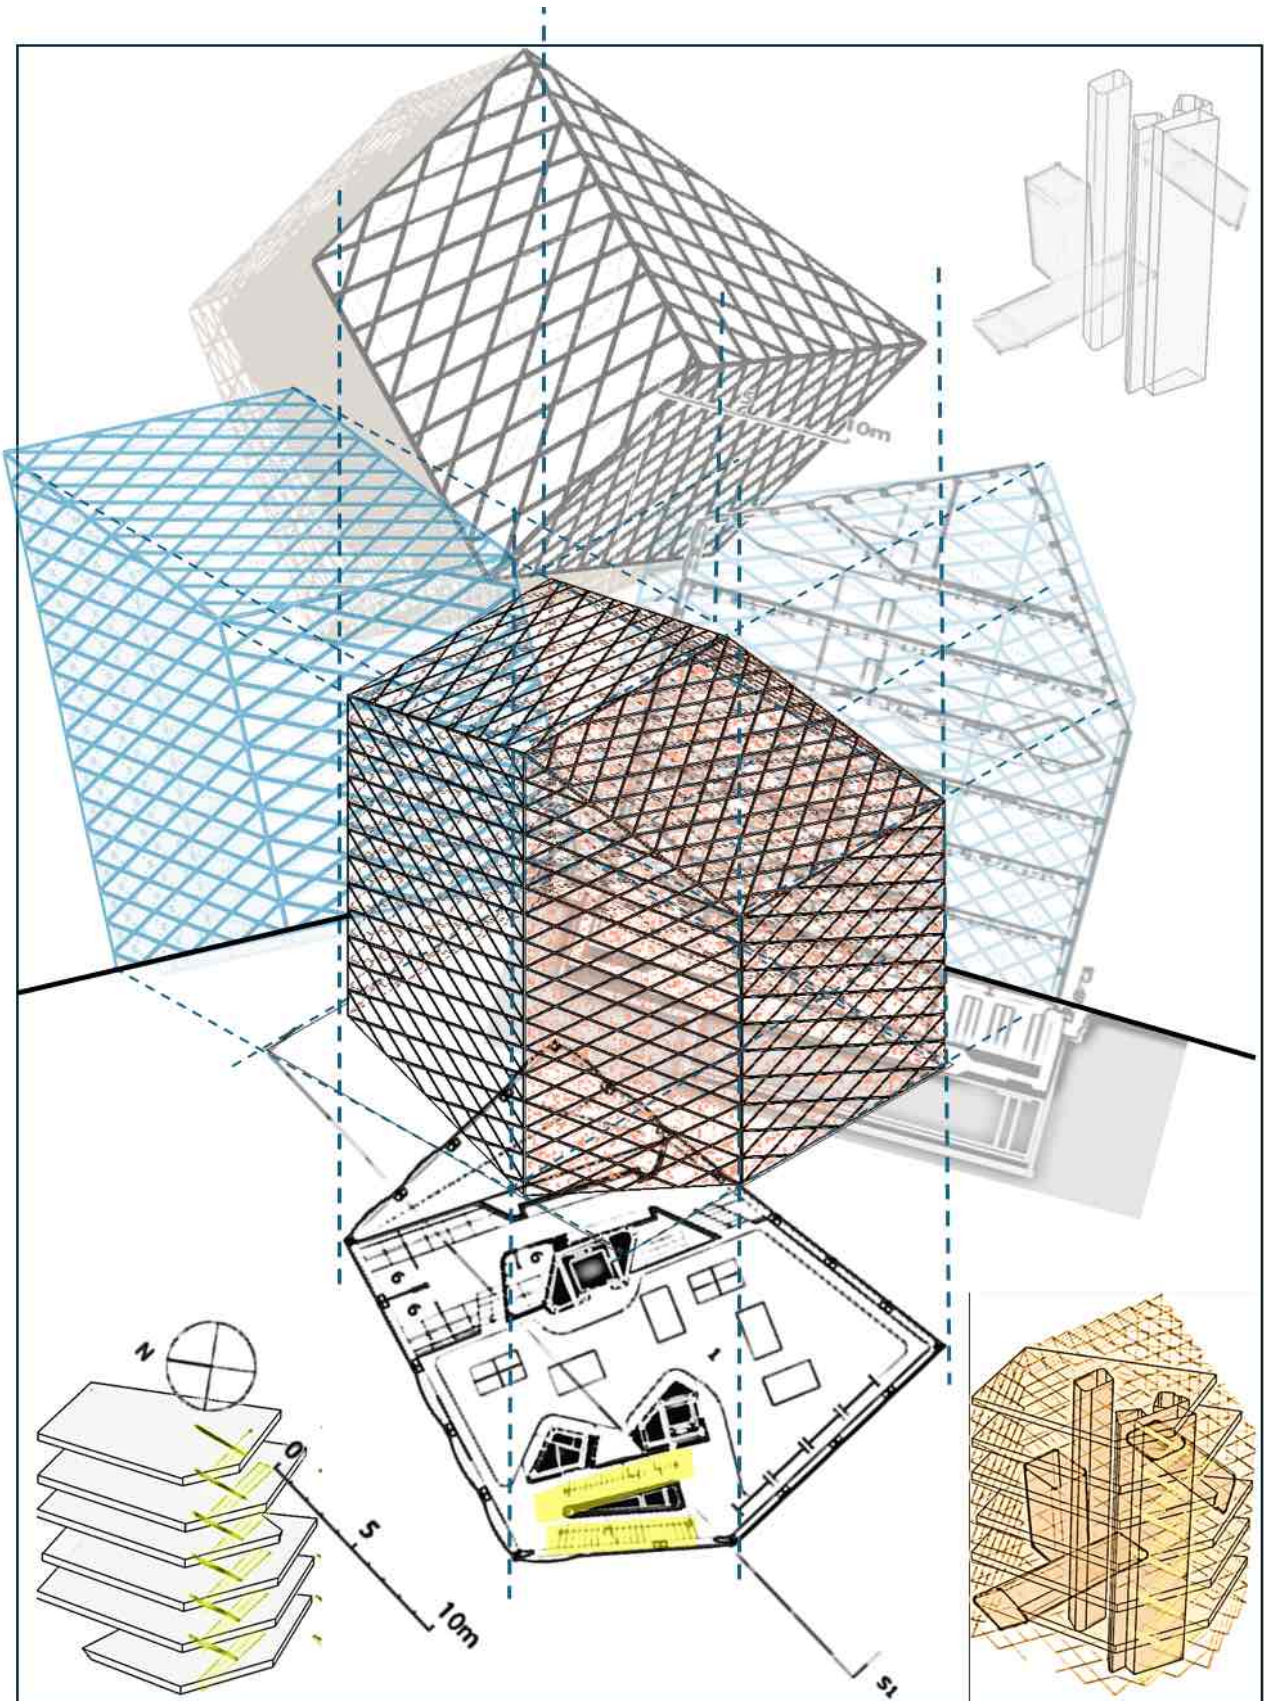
Assonometria ortogonale isometrica del poliedro che rappresenta l'edificio Prada in relazione di affinità ortogonale con la pianta del piano terreno, due prospetti; inoltre, con schemi morfologici sulla costituzione del corpo edilizio.
